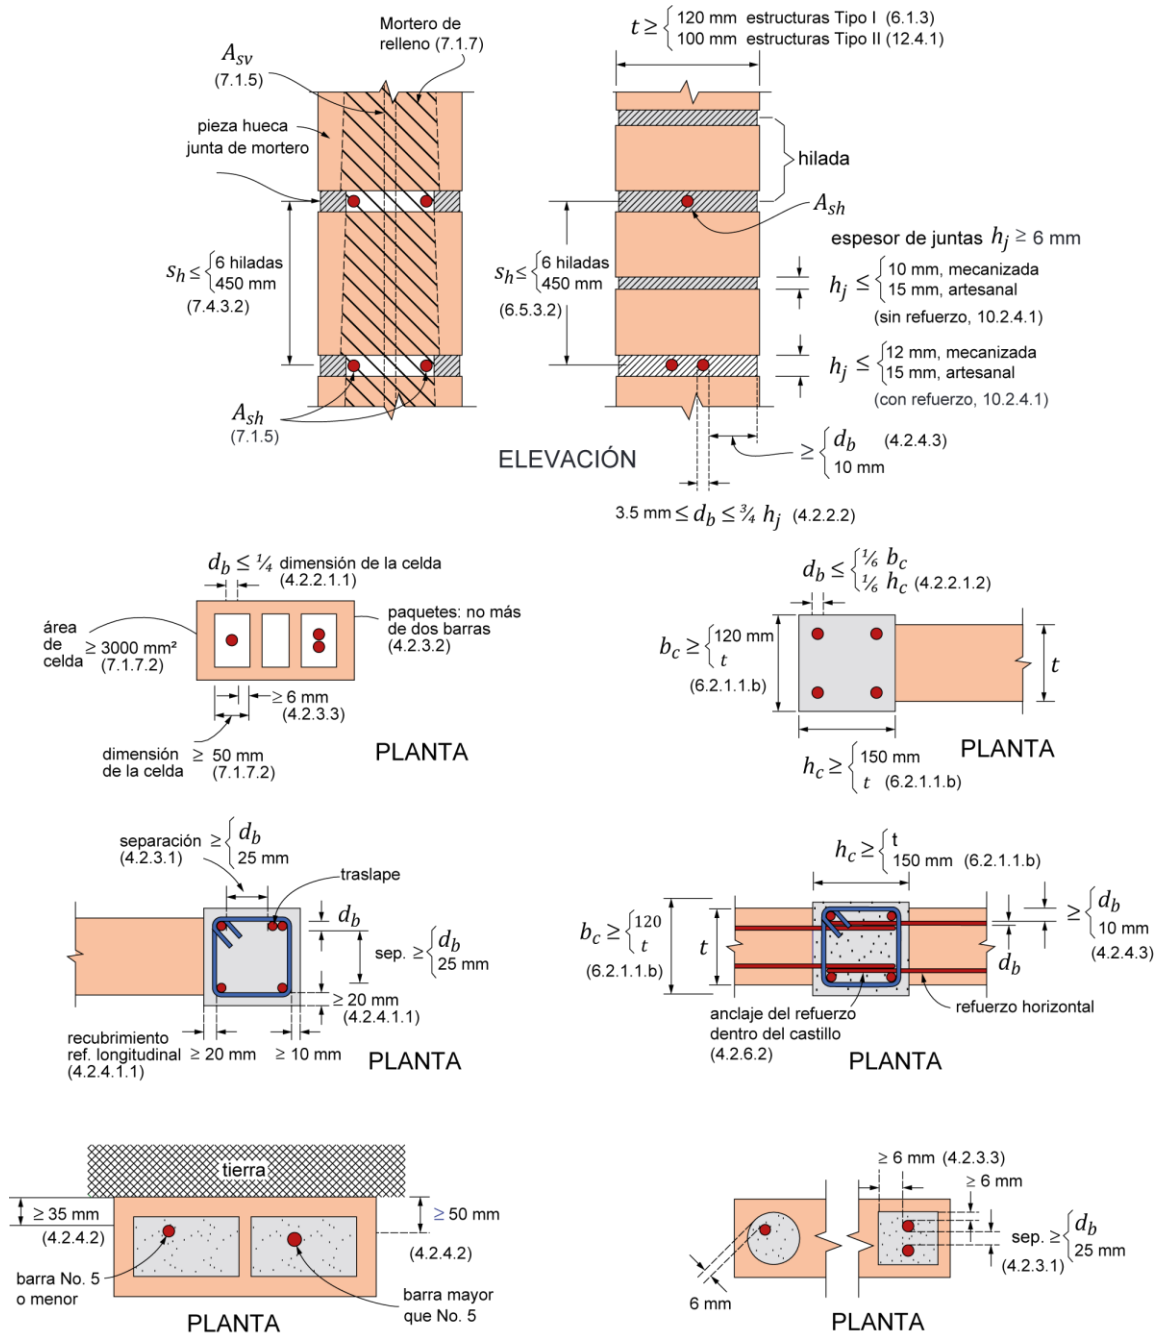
Tamaño, colocación y protección del acero de refuerzo
